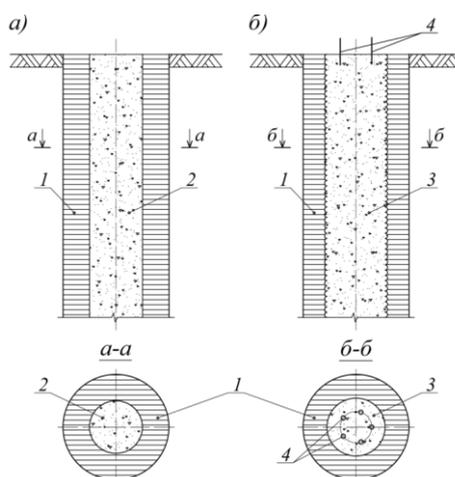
Схема устройства грунтобетонной сваи (ГБС)
